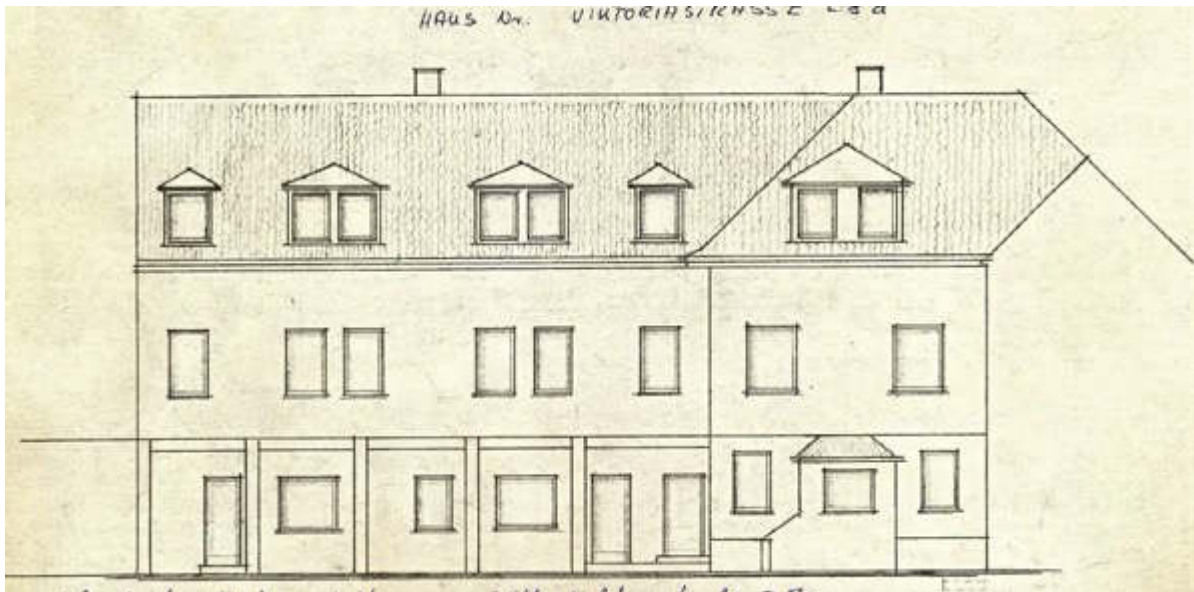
Ansicht Hofgebäude (Teilbereich 2, zugänglich über den Hof hinter dem Haus Nr. 14)
